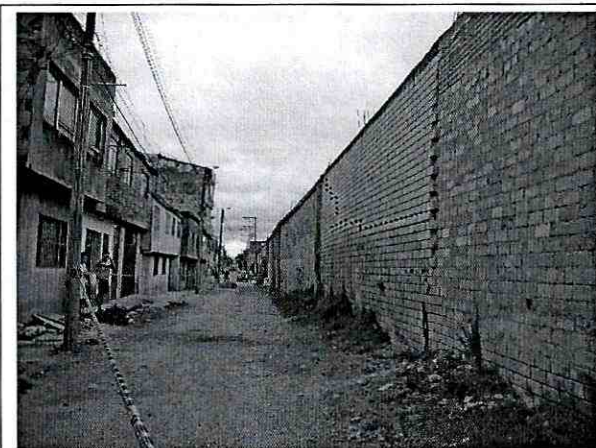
Vista del muro afectado desde la Carrera 113 entre Calles 20B y 20C, evidencia de los agrietamientos y deformaciones.
